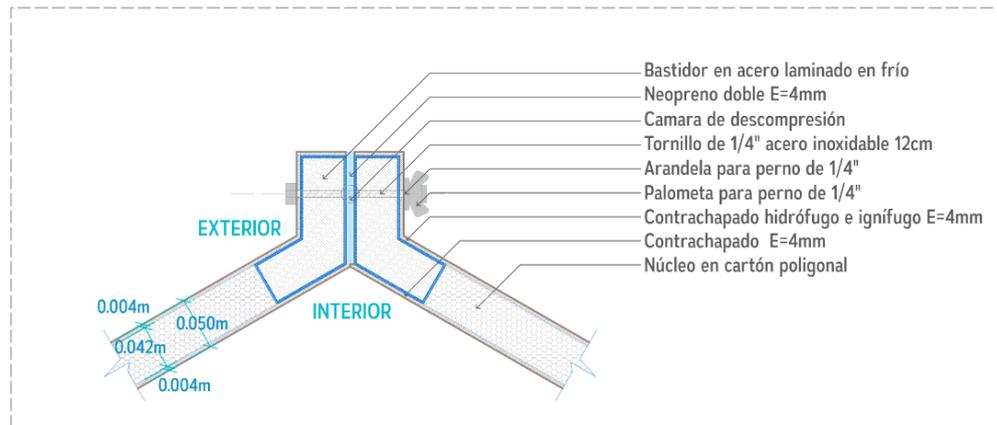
, Detalle en planta de anclaje entre paneles, fuente: Autor.
